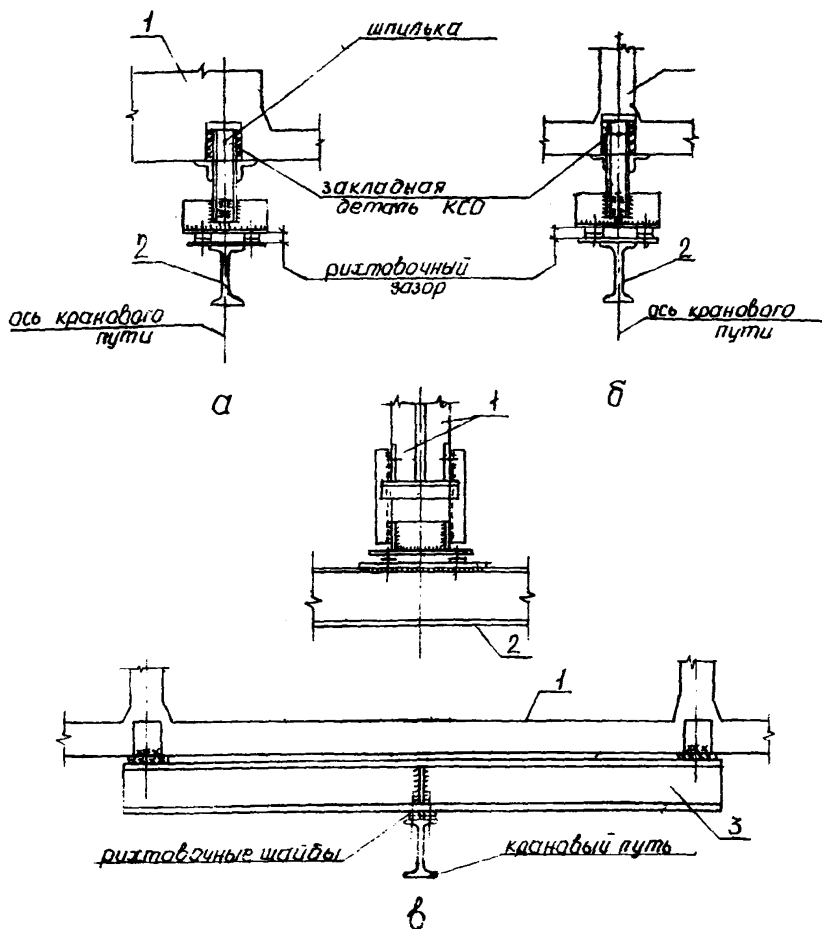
Узлы крепления путей подвешенного транспорта к нижним поясам ферм - диаграмм
